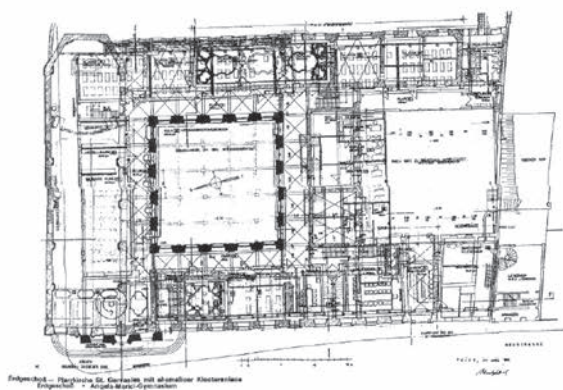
Совмещенные два плана: План 1-го этажа бывшего монастыря
